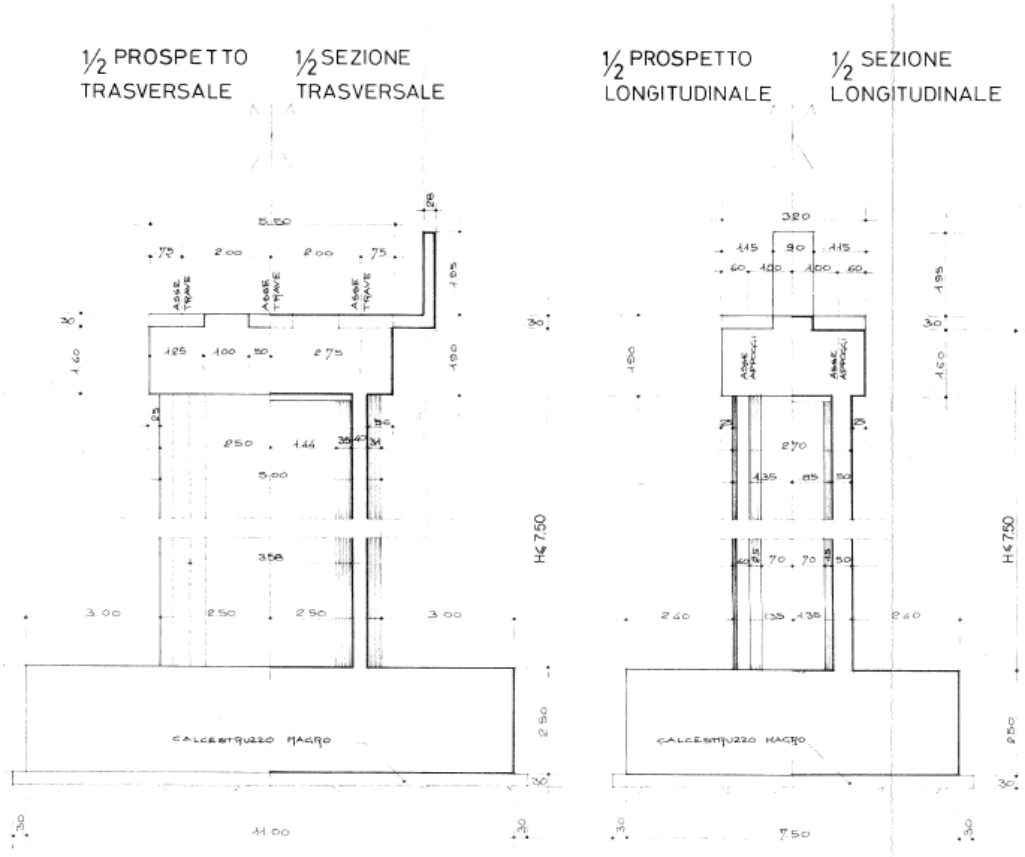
Prospetto Longitudinale e Trasversale Pila
